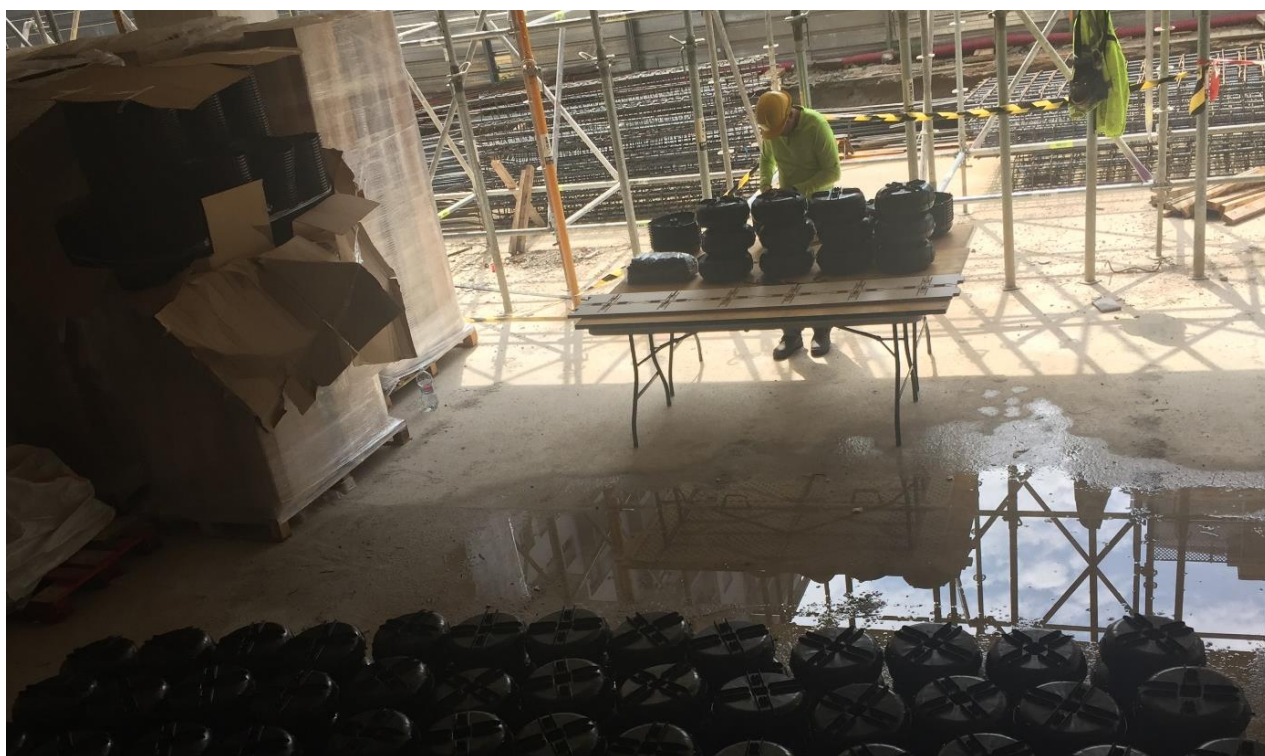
Palets con piezas desmontadas y zona de ensamblaje.
